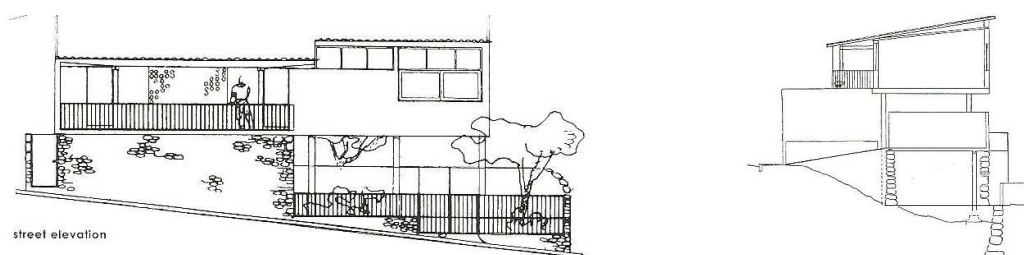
a - 170.b. OSCAR NIEMEYER, 1940. RESIDENCIA CAVALCANTI, ALZADO CALLE Y SECCION. (REF.ON.1940.SP.2008.182 - ON.1940.PG.1943.164b)
